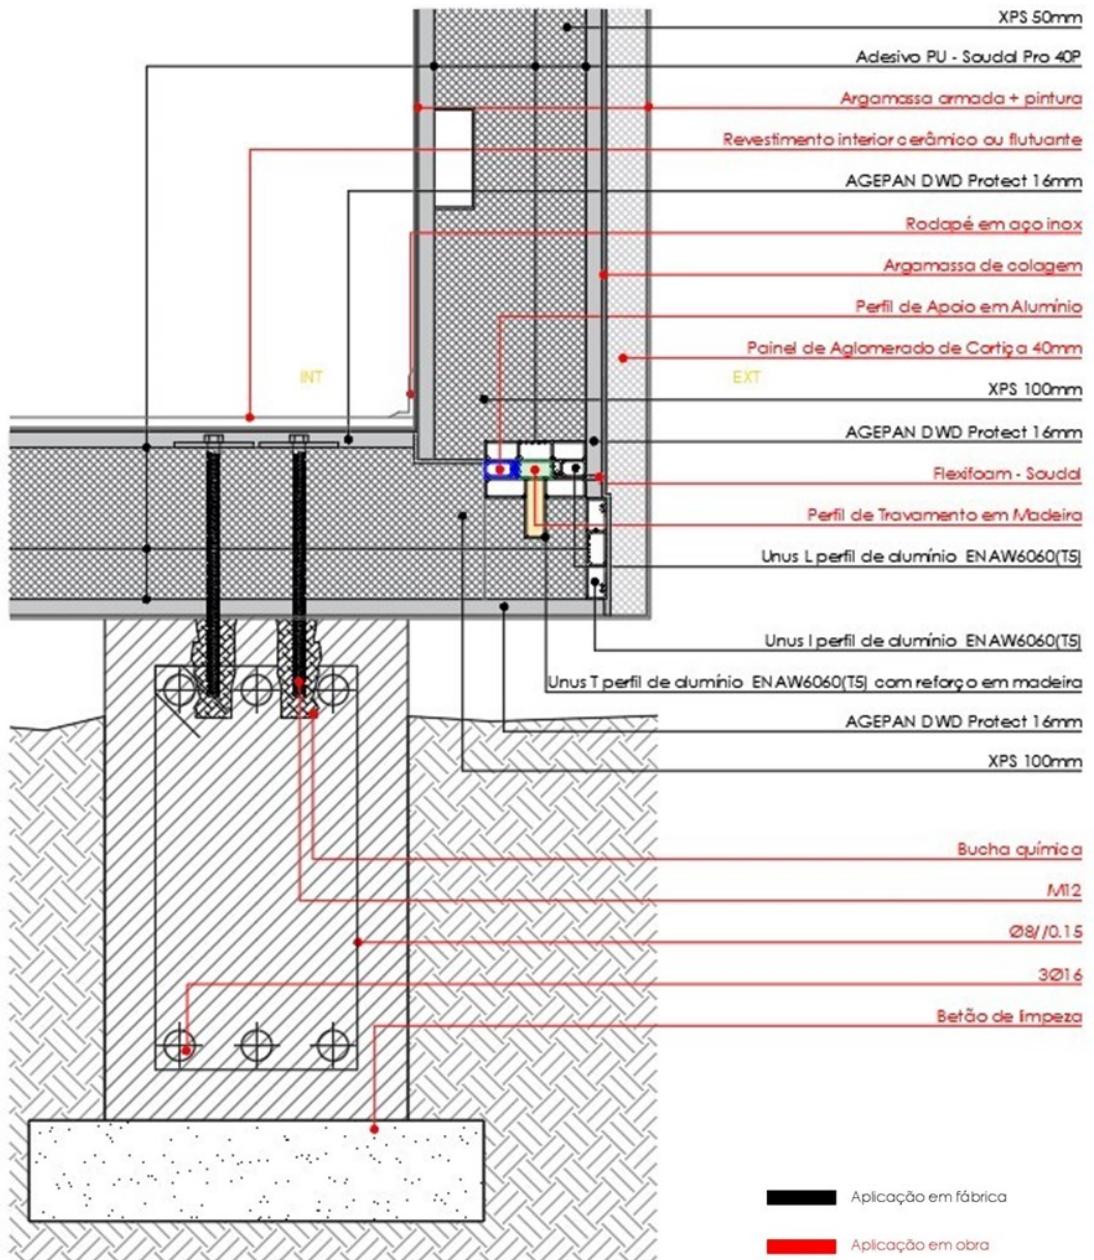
Solução Final – Pormenor construtivo de ligação de fundação em betão, com piso e parede.
